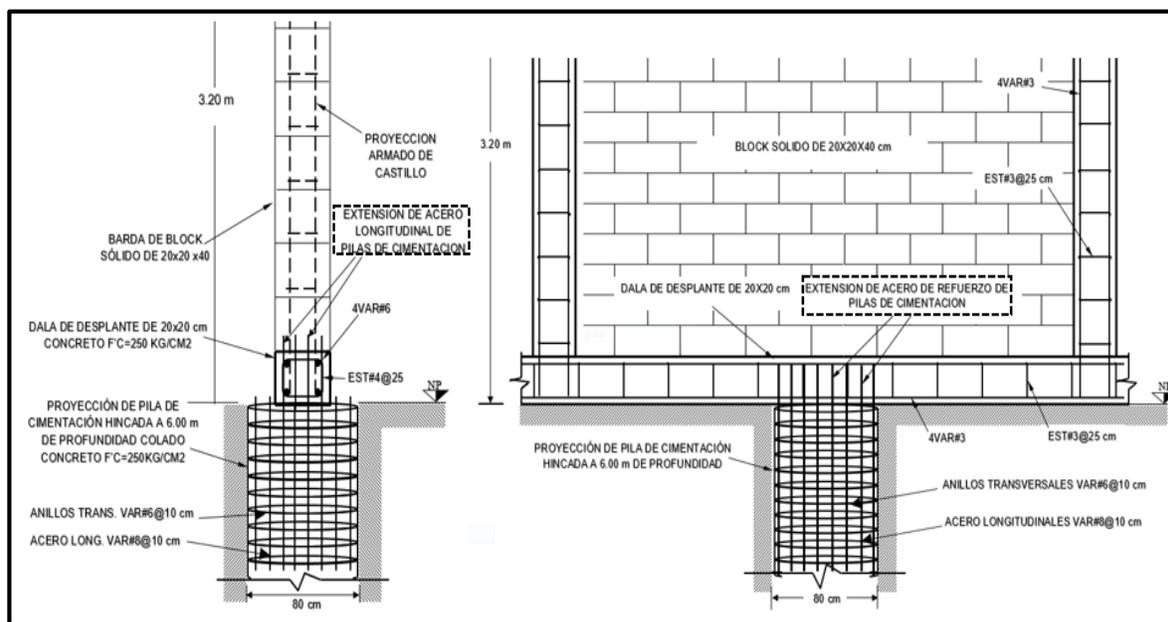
Extensión de varilla longitudinal de pilas de cimentación
